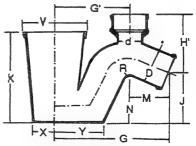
VII Piletas de piso en "Q"con ventilación.
